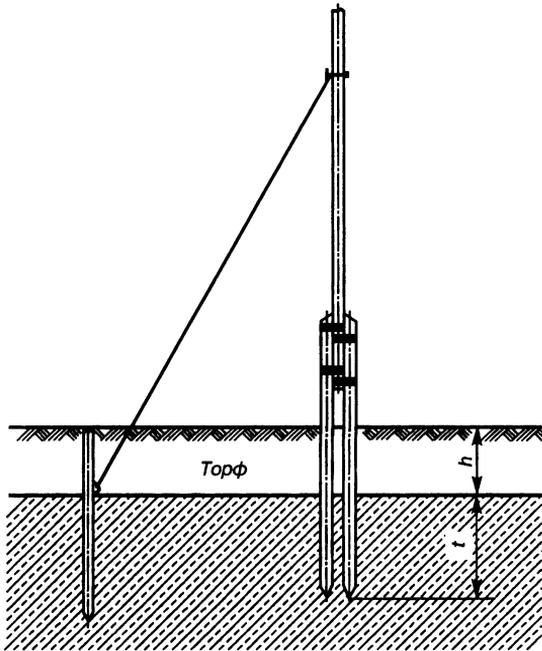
Опора со свайным закреплением оттяжки
